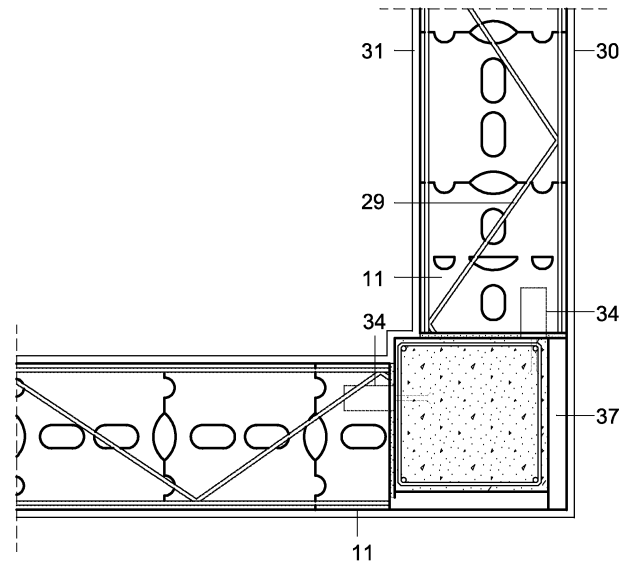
Encuentro con pilar en esquina hilada impar. Muro portante. Bloque de longitud 30.
